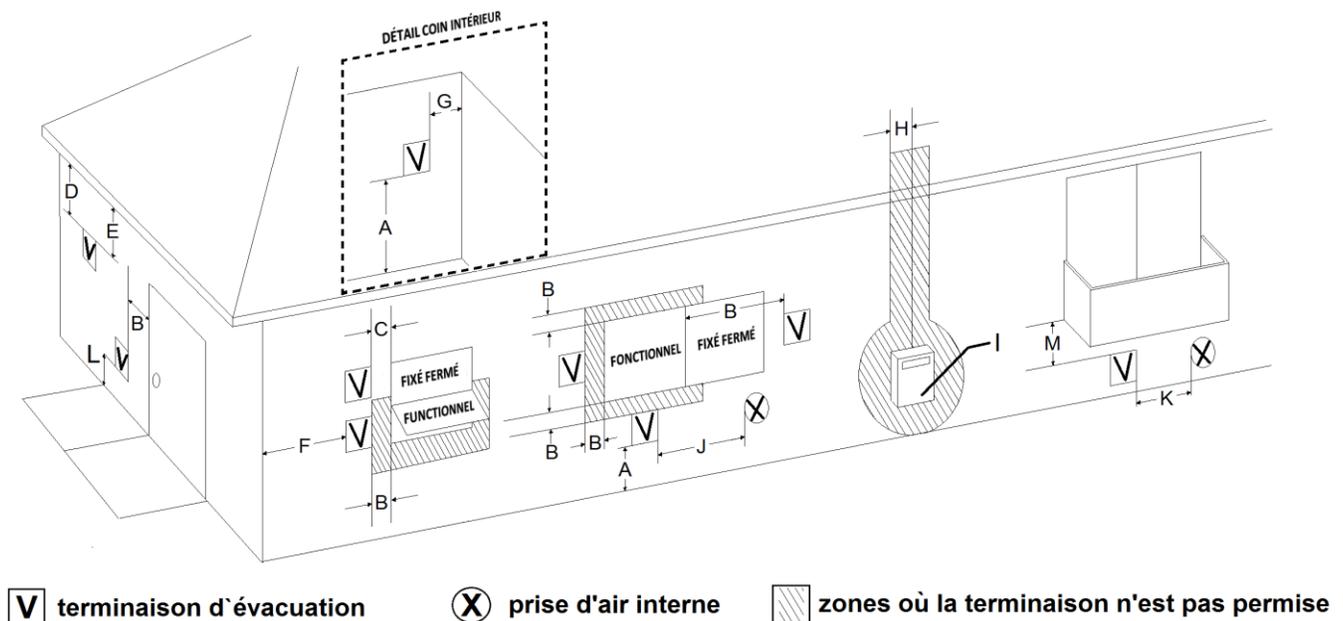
Emplacements acceptables d'un Chapeau de Terminaison
